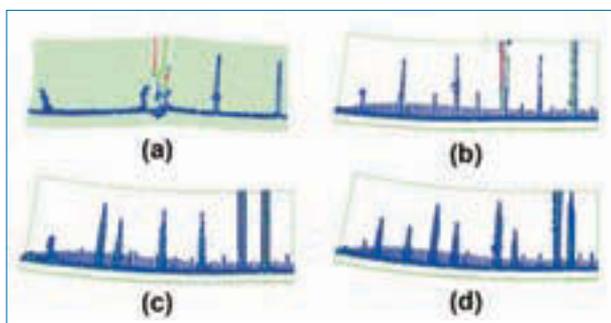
Quadri fessurativi dovuti a deformazioni impresse in un muro in calcestruzzo lungo 30 m e alto 5 m, nel caso di perfetta aderenza con la fondazione, al variare dell'armatura: a) muro non armato, b) muro armato, $\rho_s = 0.048\%$, c) $\rho_s = 0.13\%$, d) $\rho_s = 0.26\%$.
